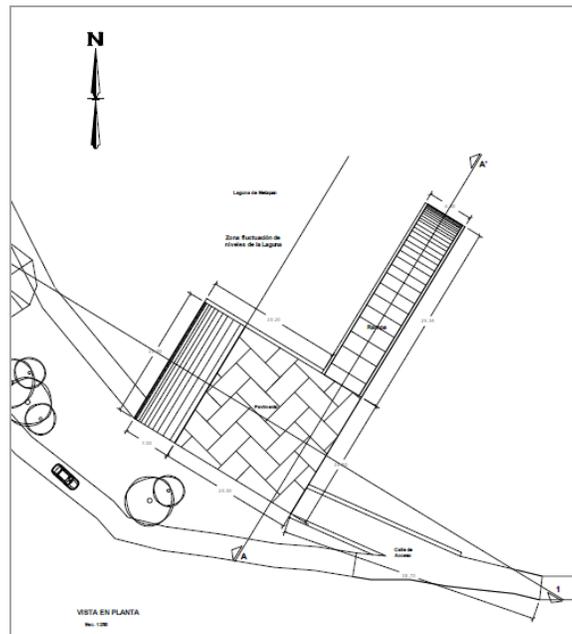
Vista en Planta Propuesta de Diseño de Pavimento y Rampa.
